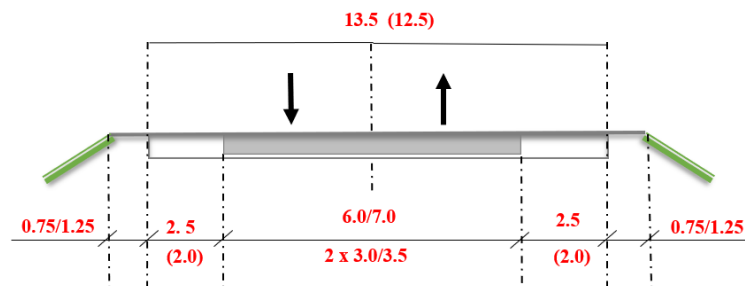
Typowe przekroje dróg głównych ruchu przyspieszonego GP [128].
